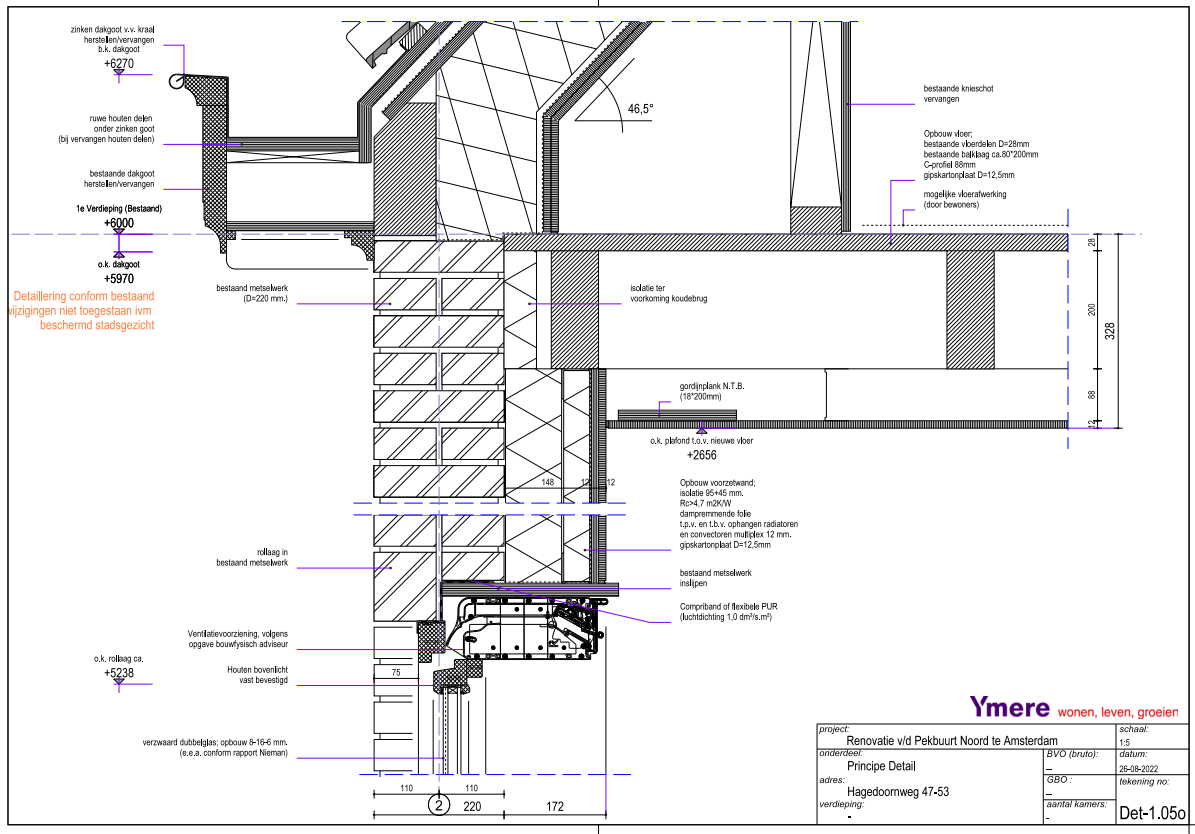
A.7 Detail Ventilatie ramen voorgevel met suskast
